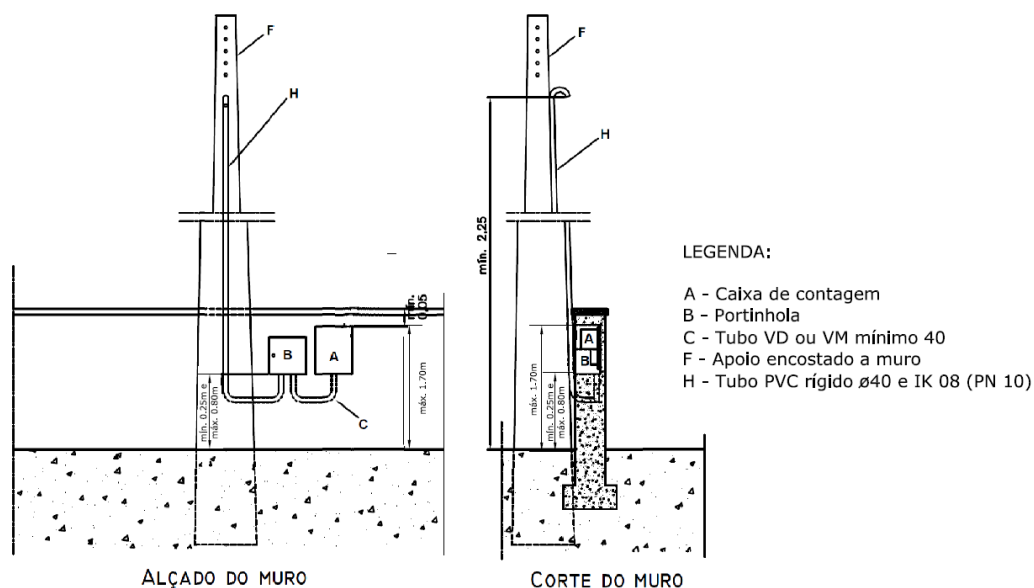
Ligação a partir de rede aérea de edifícios com uma instalação de utilização dotados de muro sem pilar (poste encostado ou intercalado no muro)
